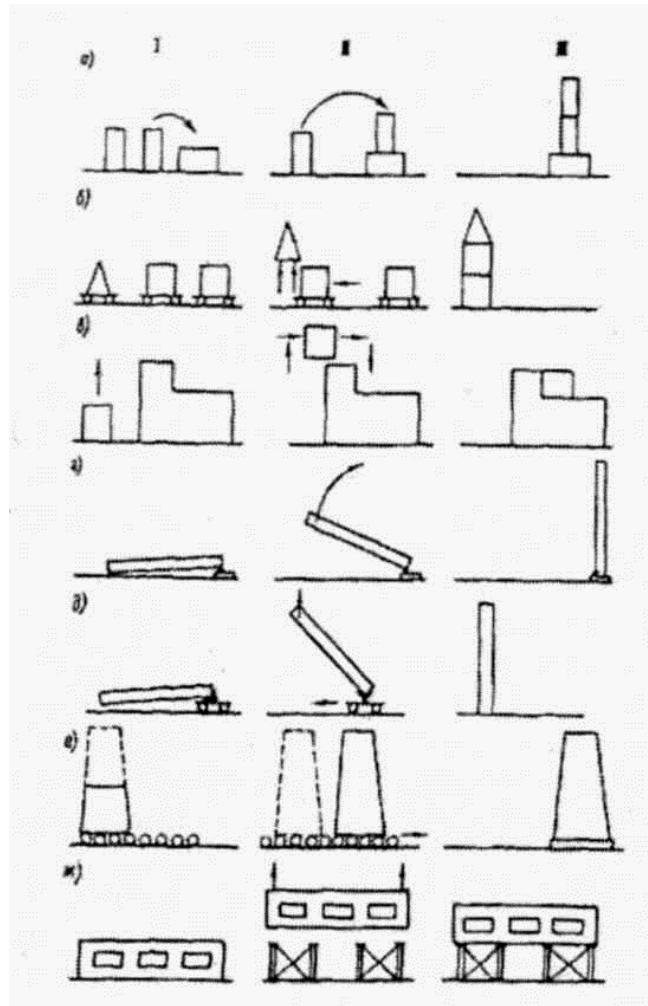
Основные способы монтажа конструкций: а – наращивания; б – подращивания; в – сложным перемещением; г – поворотом; д – поворотом со скольжением; е – надвижкой; ж – вертикальным подъемом;
